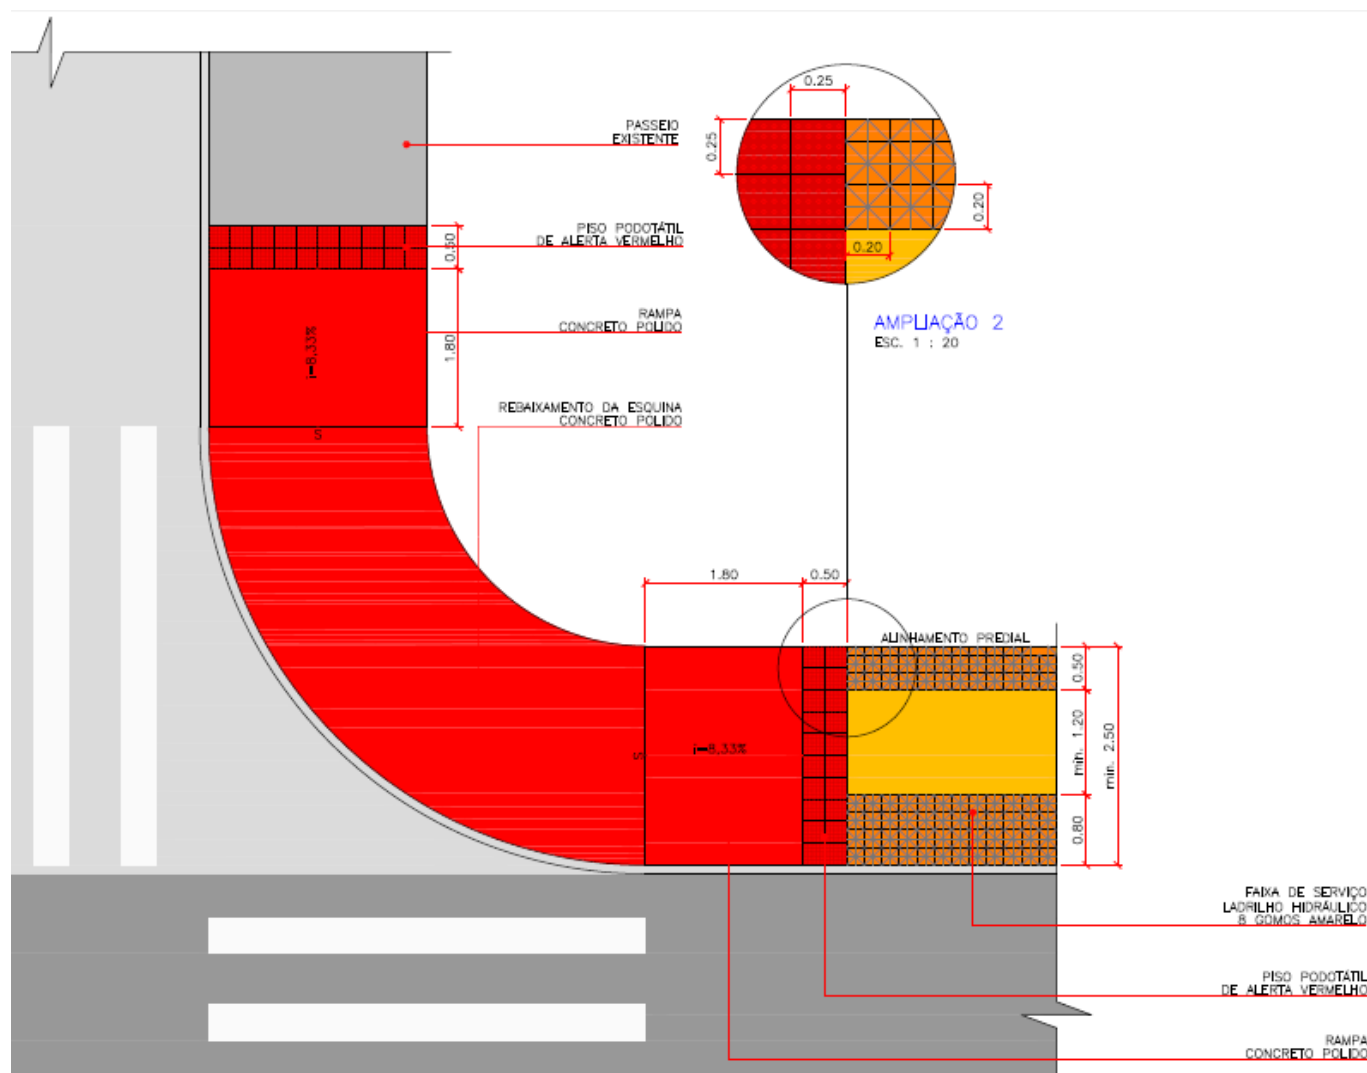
Detalhe típico de rebaixamento da travessia nas esquinas
